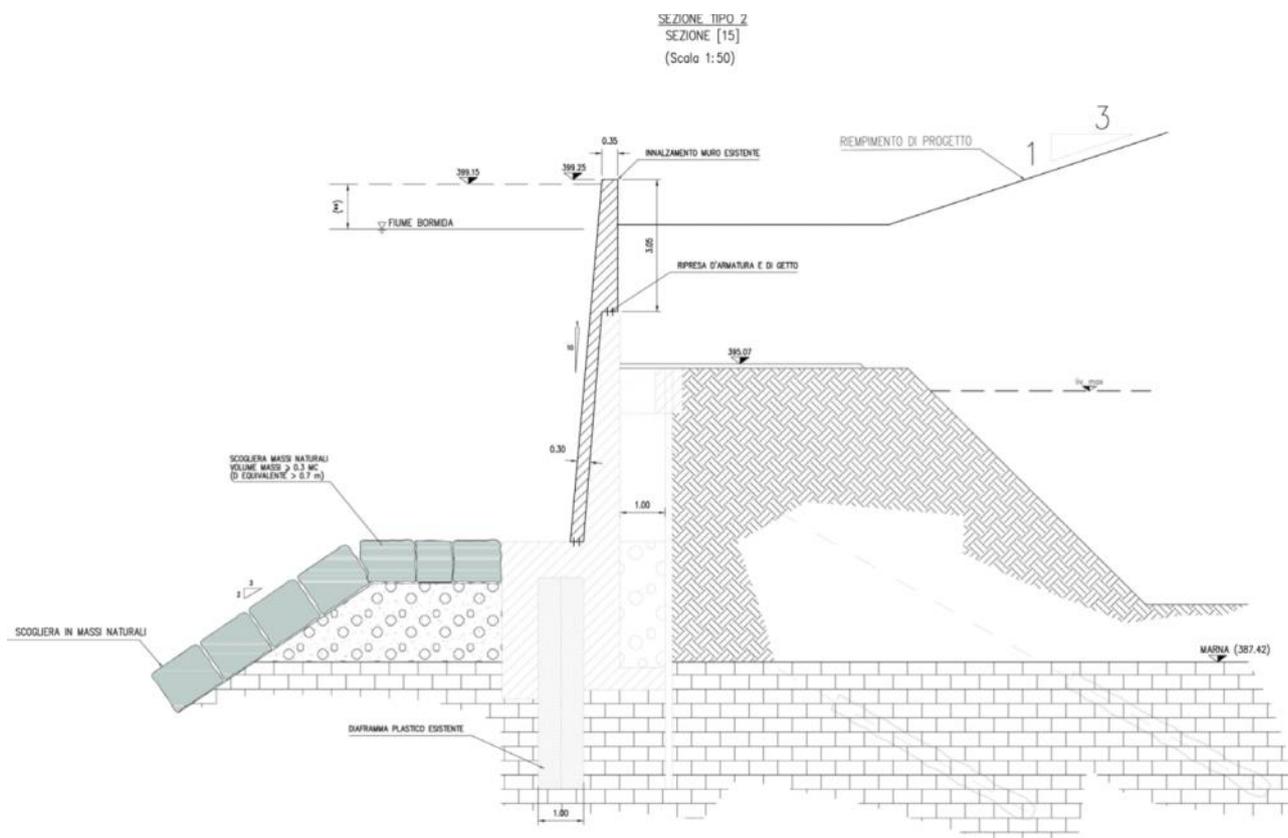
Sezione tipo della dell'opera di confinamento arginale – Tipologia 2
